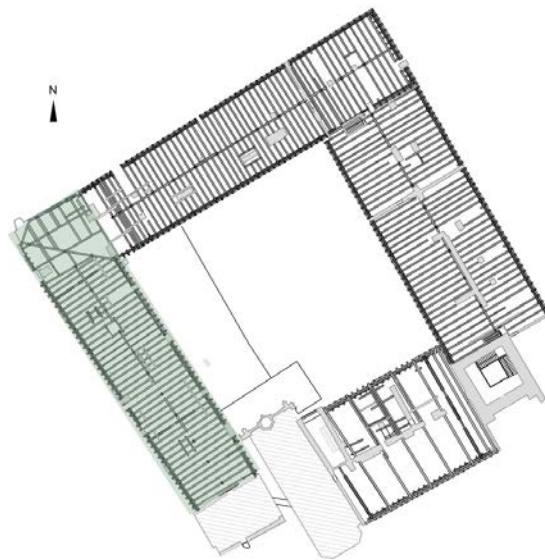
Lageplan Südwestdachwerk des Schweizerhofs mit Markierung des SW-Trakts
